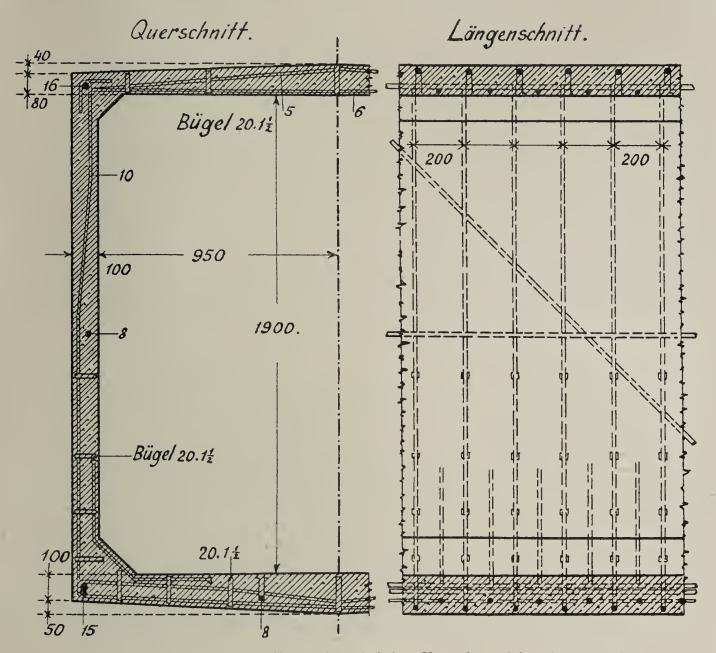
und 263. Wafferkanal beim Ban des Simplontunnels.
